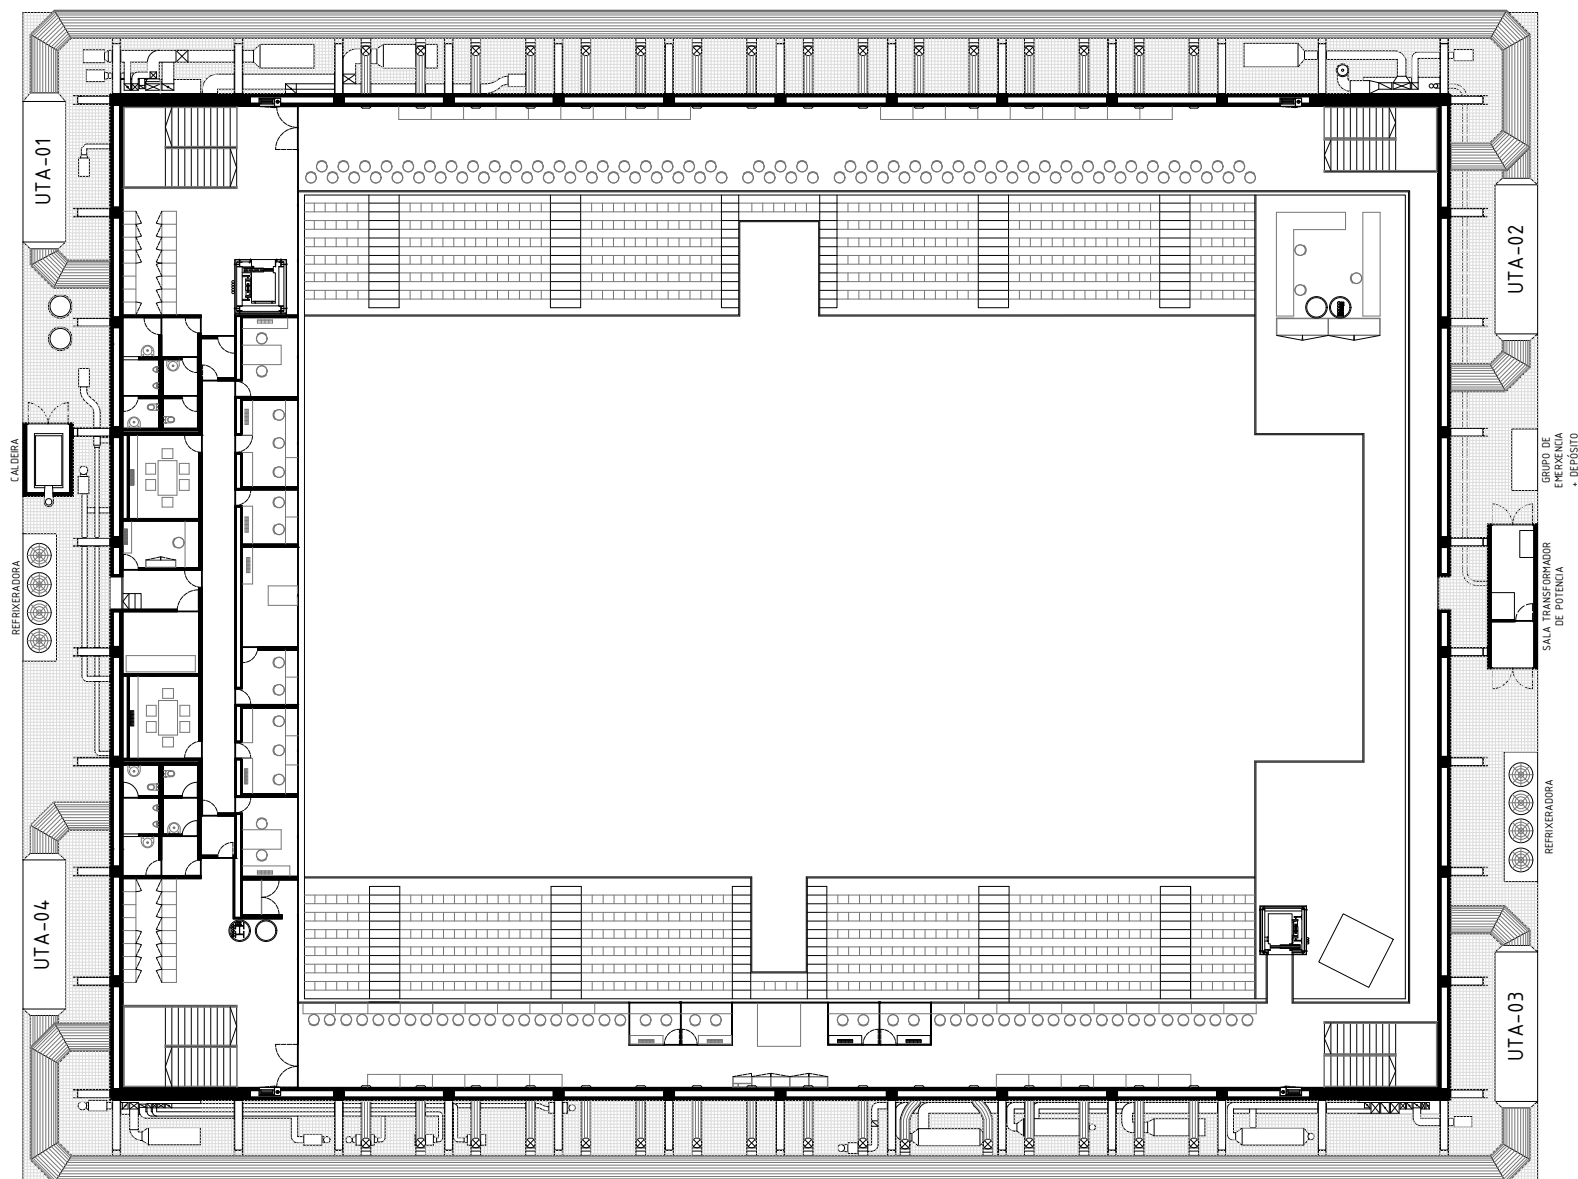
Planta primeira do Centro Cultural. Escala 1/350.
